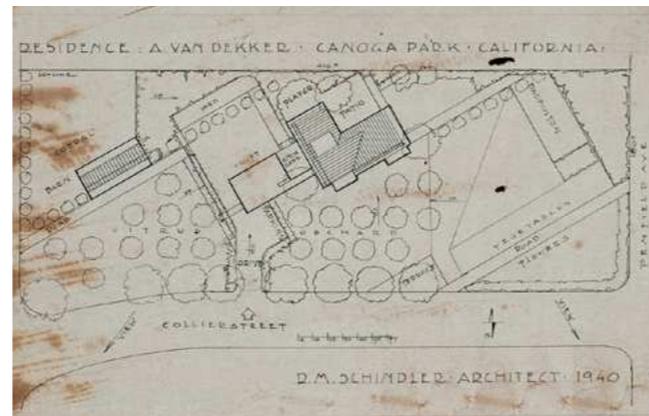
, Originalzeichnung R. M. Schindler, Van Dekker Haus
